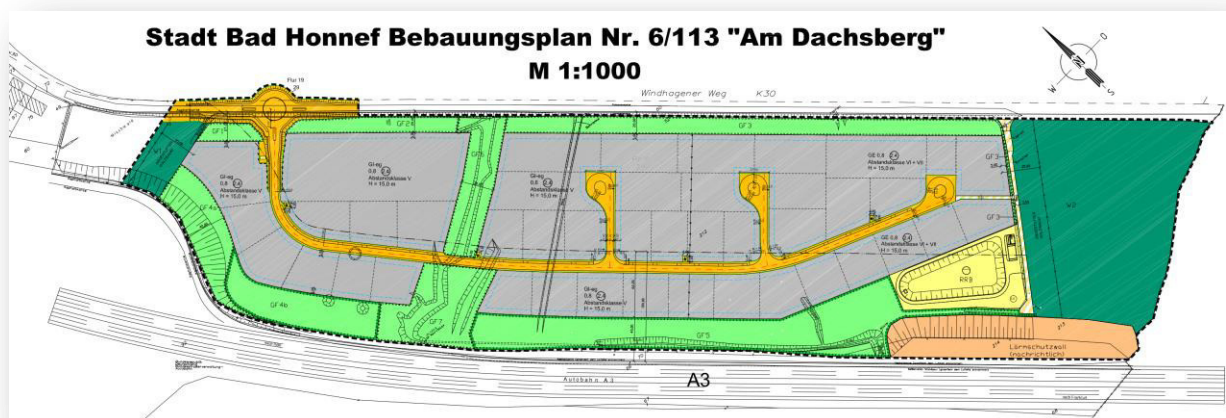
Bebauungsplan Nr.: 6/113 „Am Dachsberg“, der Stadt Bad Honnef
